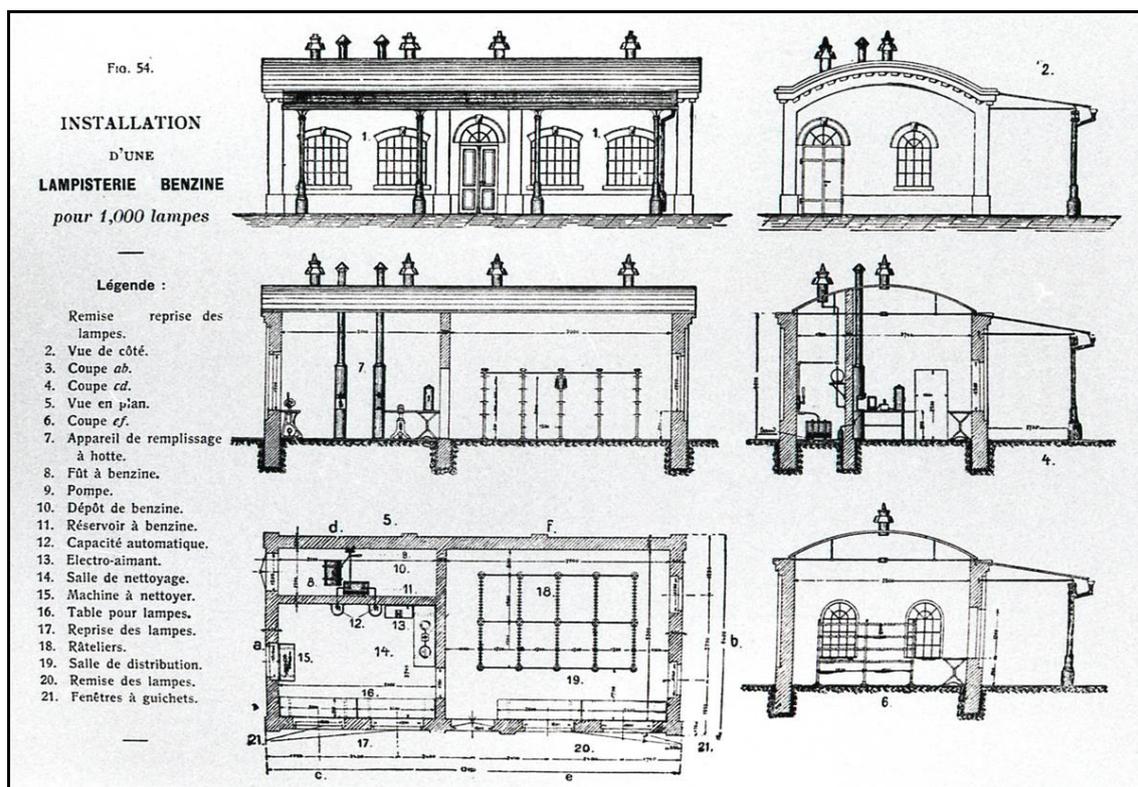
Lampistería de Joris (Arch. J.M. Sanchis)
